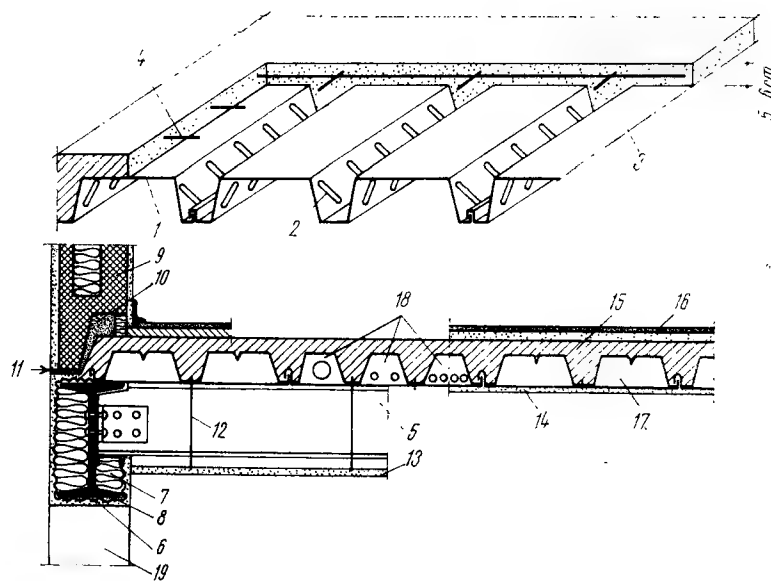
Vedere și secțiune transversală printr-un planșeu mixt:
